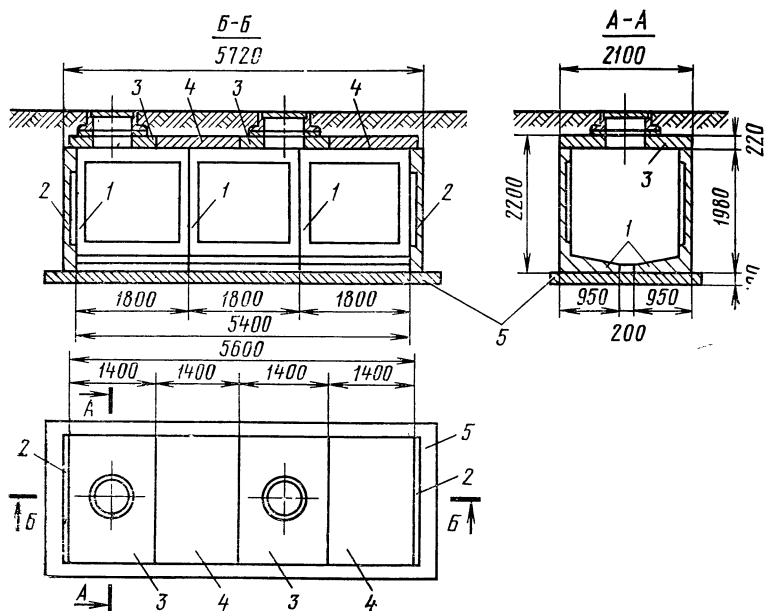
Вариант сборки нетипового железобетонного колодца длиной 5,4 м:
